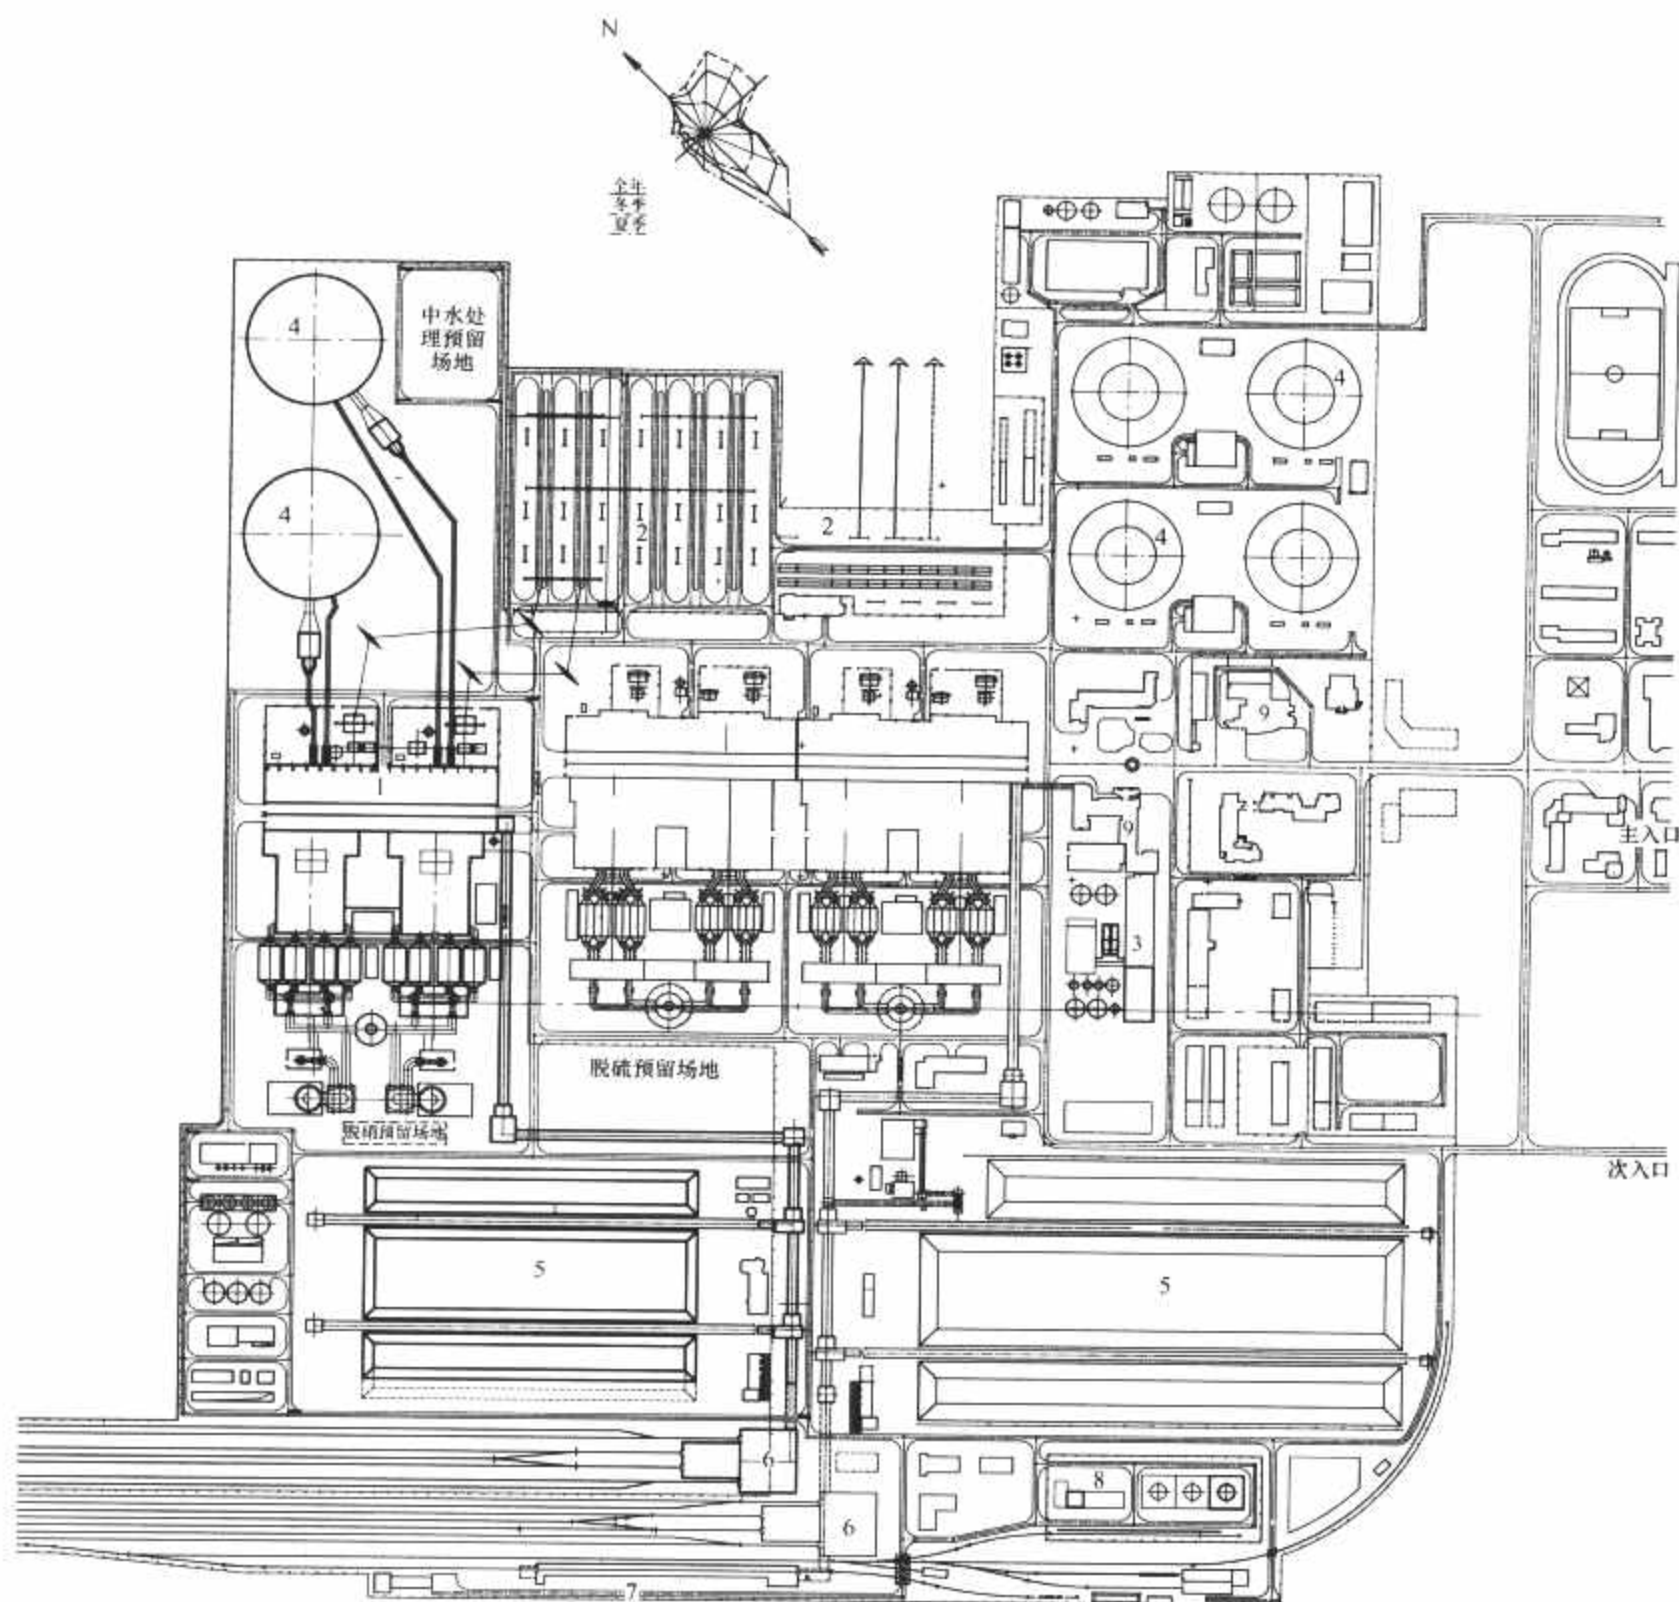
冷却塔布置在固定端的电厂总平面布置图
